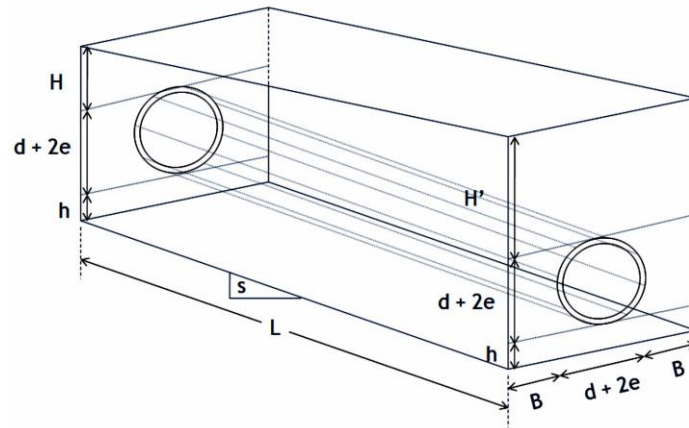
Proyección del trapecio que produce el área excavada para una tubería de alcantarillado. Tomado de (CIACUA, 2013).
